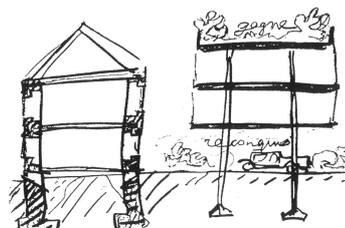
Esquema comparativo de Le Corbusier sobre la construcción con muros de carga y con estructura reticulada de pilares.
